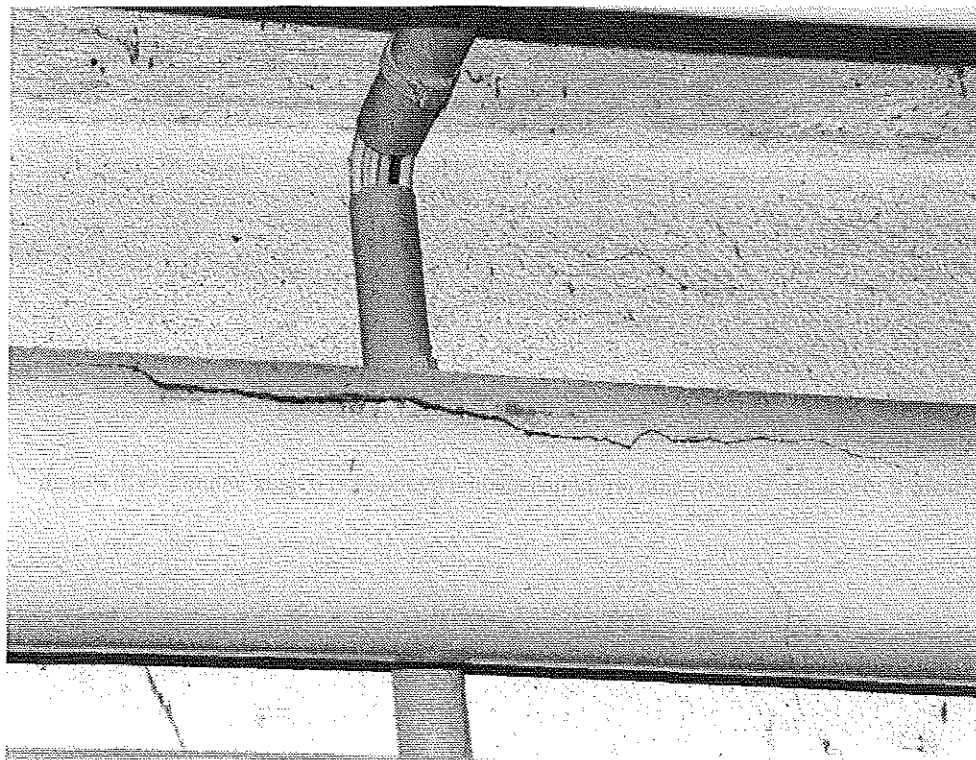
Fissuration longitudinale sur zone supérieure de la canalisation d'eaux vannes.
